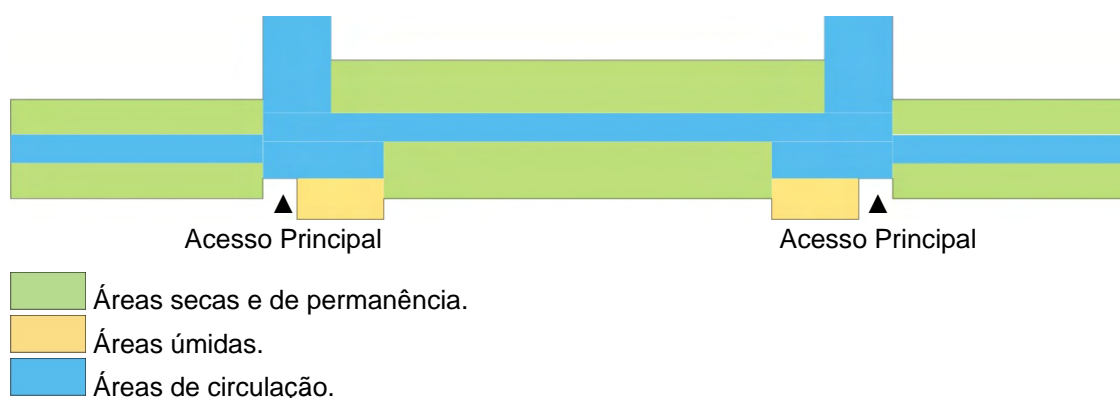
Planta tipo (esquemática do pavimento tipo) do Edifício do CCE.
